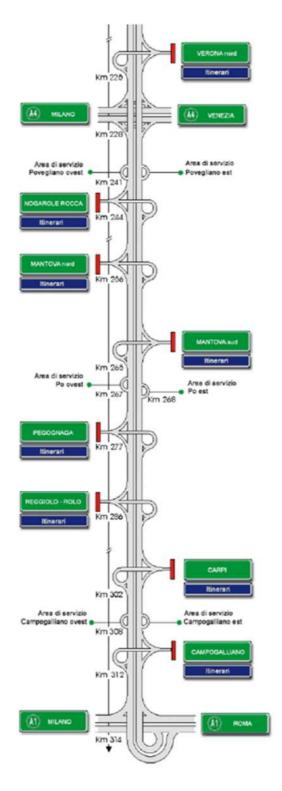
Schema tratto autostradale oggetto dell'intervento
